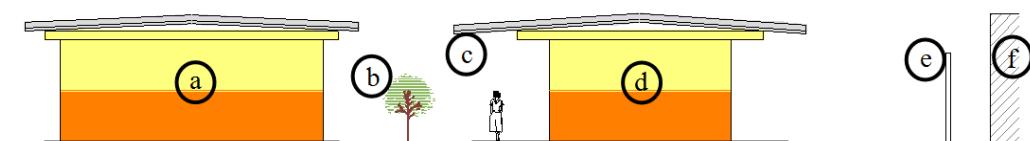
Barreiras construtivas para insolação direta; a- Ala de salas de aula, b-Vegetação, c- Beiral, d- Salas de aula analisadas, e- Muro, f- Construção vizinha
